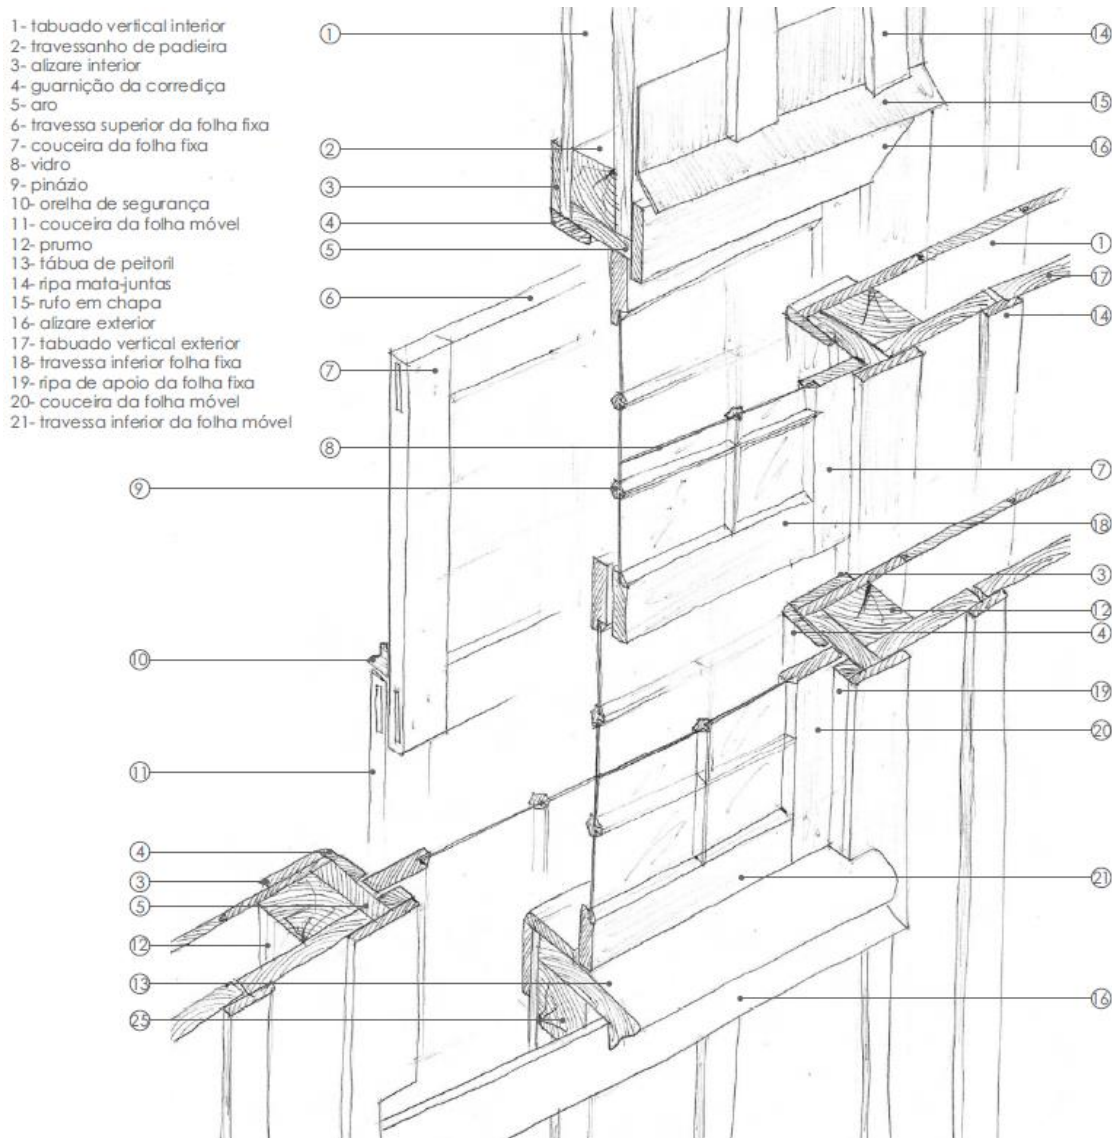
Pormenor tipo da janela de guilhotina (fonte: Moutinho (2007))
